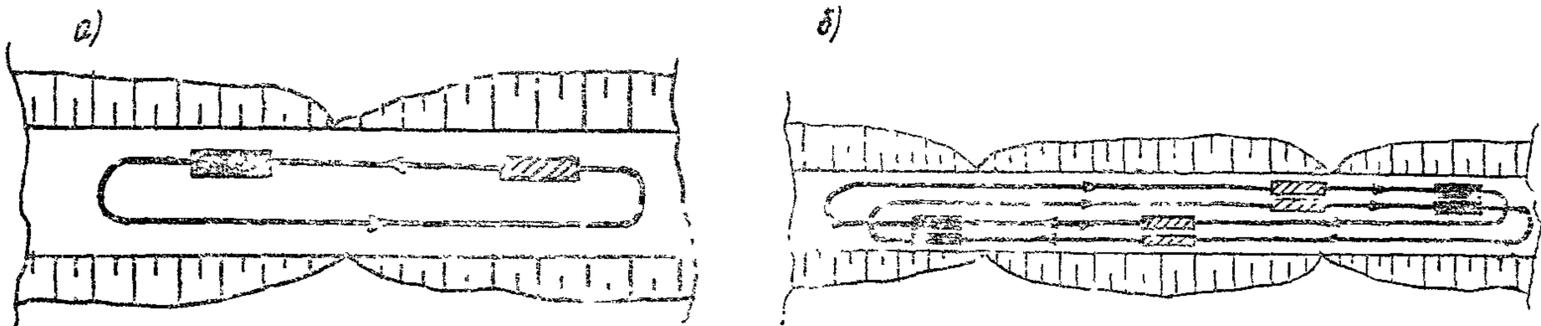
Схема движения скрепера при разработке грунта в выемке с перемещением его в насыпь:
